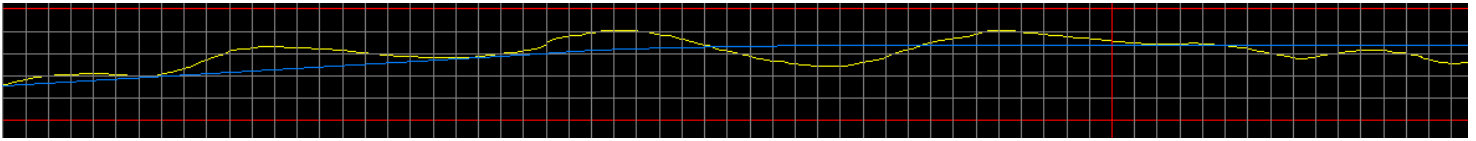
Vista general del inicio del alineamiento vertical con cortes y terraplenes sobre el terreno (AutoCAD 2010).
